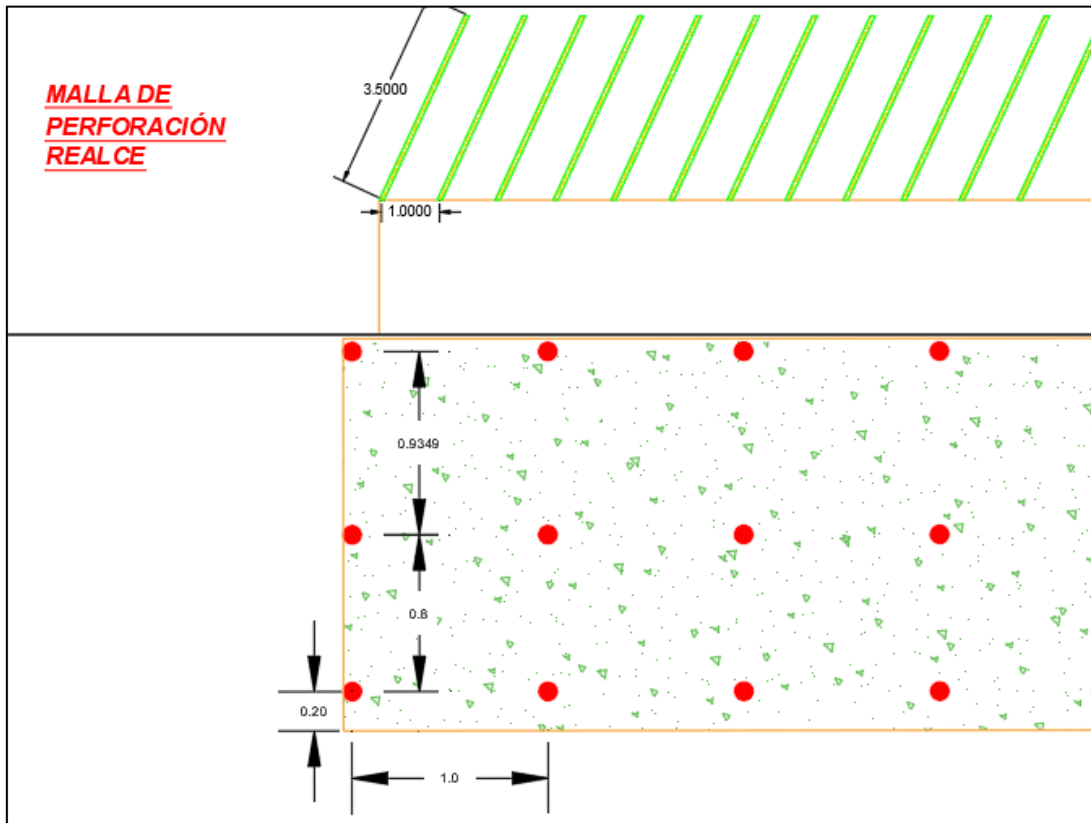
Plano en planta del circado en realce en el tajo L-598 V5
